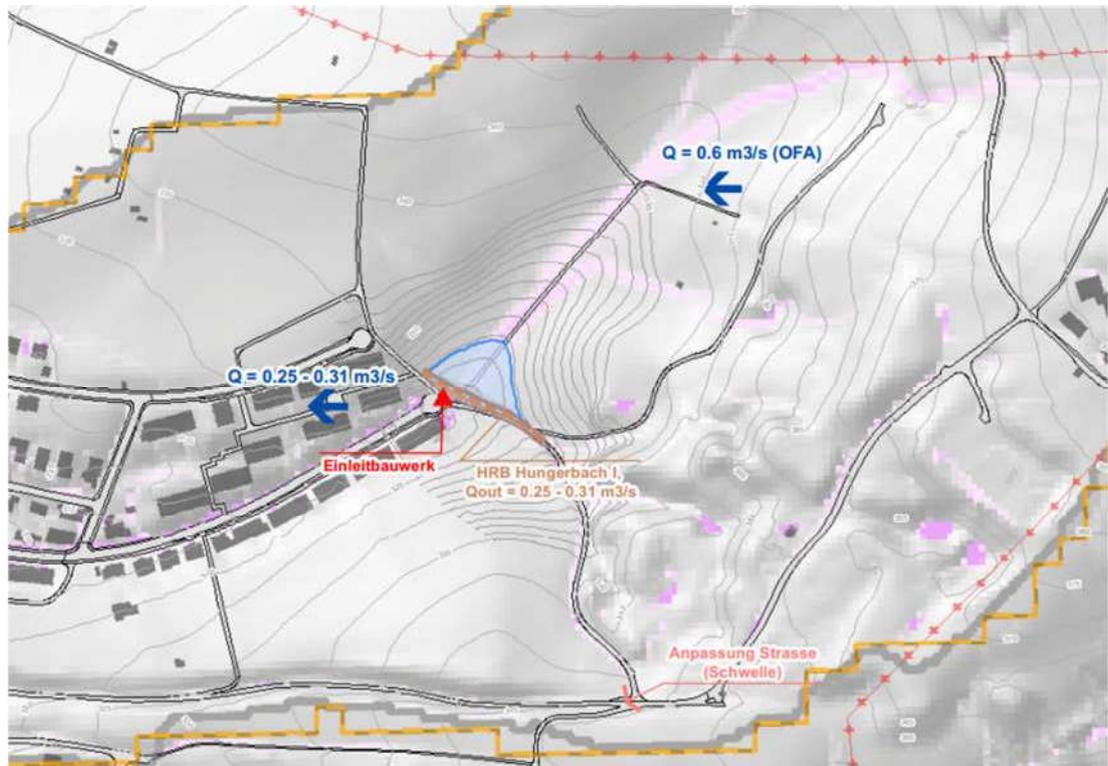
Ausschnitt aus dem Situationsplan Variante 1
